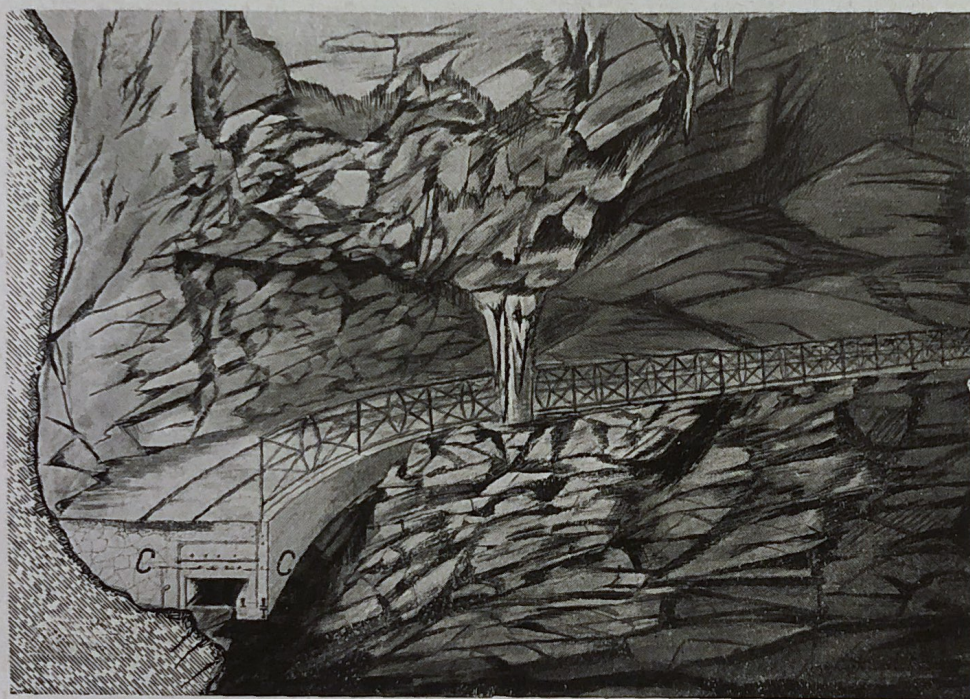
SCHEMA DEL PONTE DI CEMENTO ARMATO (Dis. Piovano).
